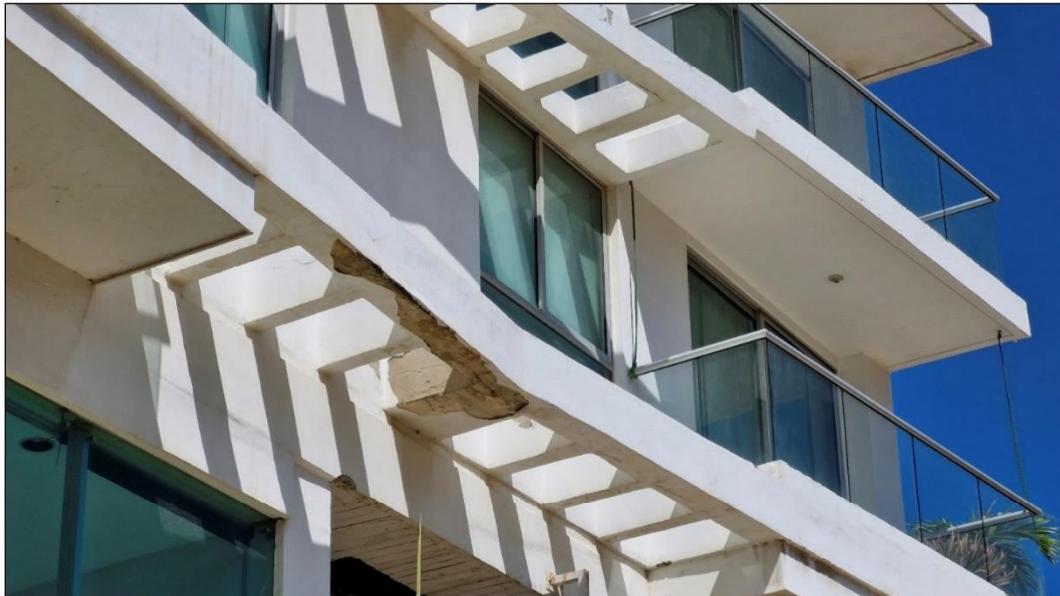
Corrosión del acero de refuerzo en elementos de la fachada
